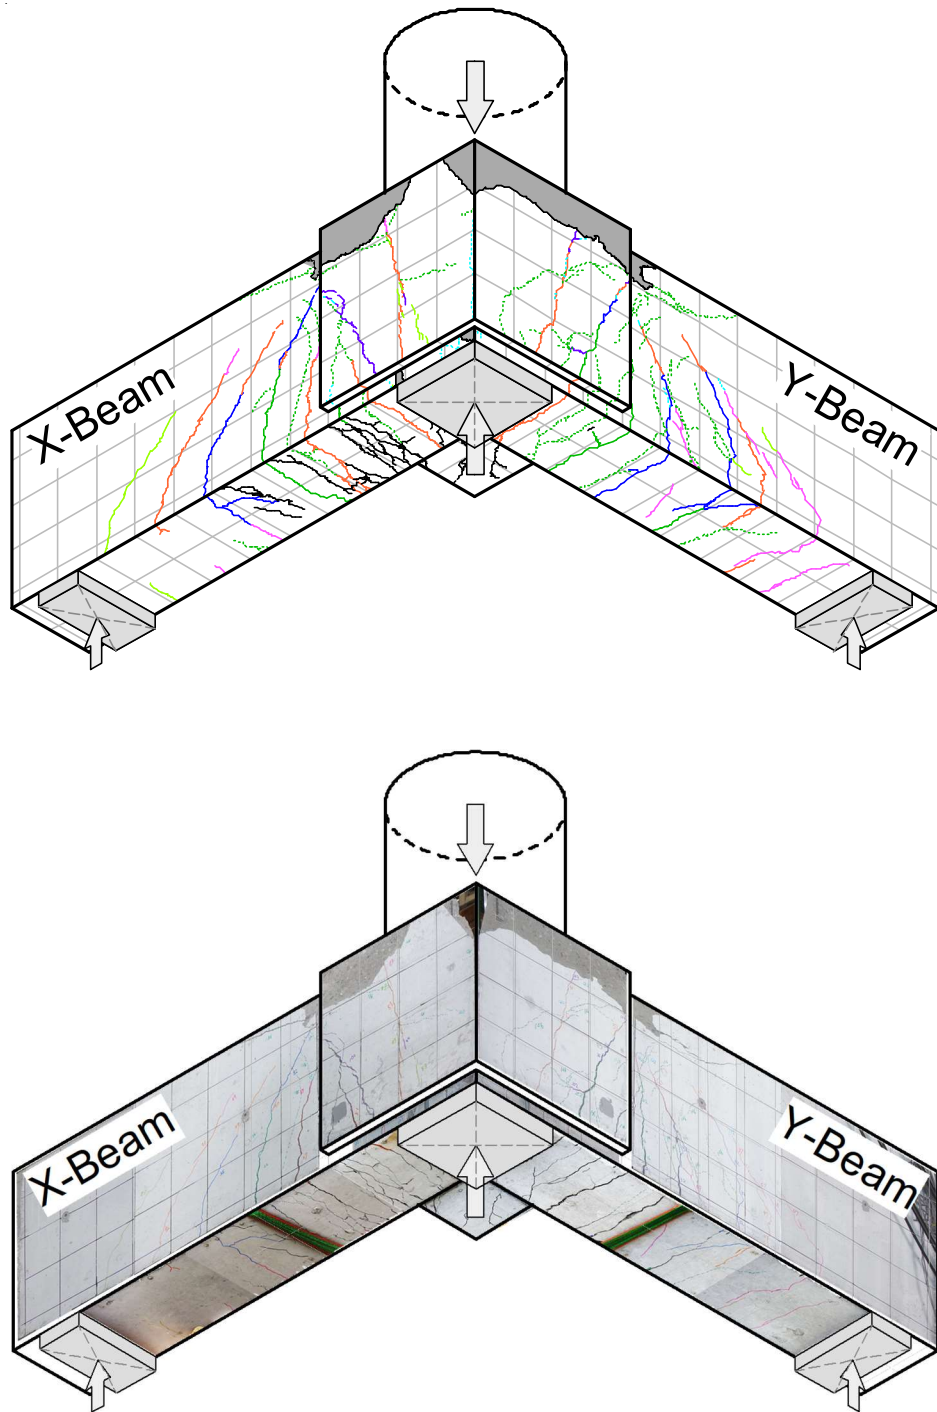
試験体 PCB 最終損傷状況—視点②
